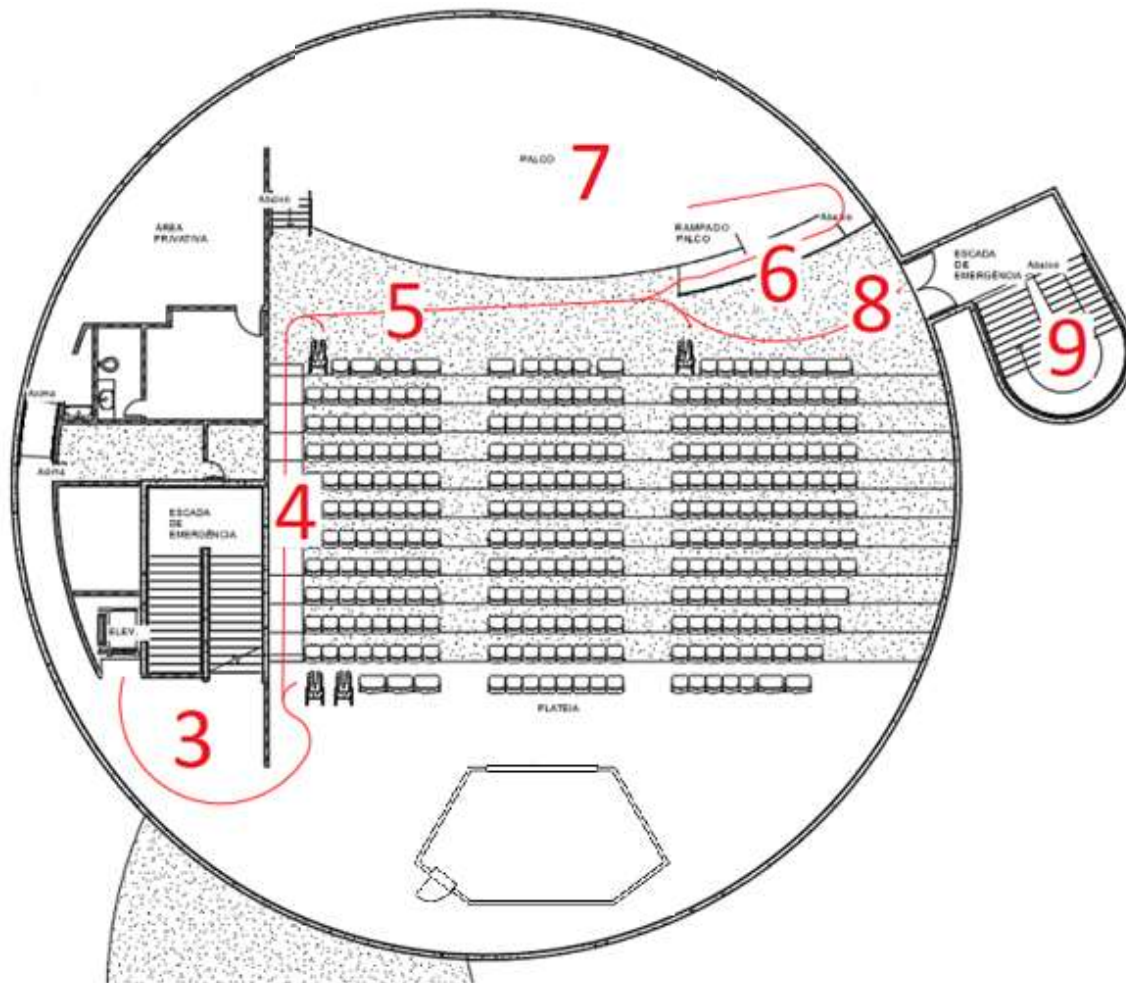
Planta Baixa Ed. Sede do CJF com indicação da Rota acessível – Pavimento Térreo
